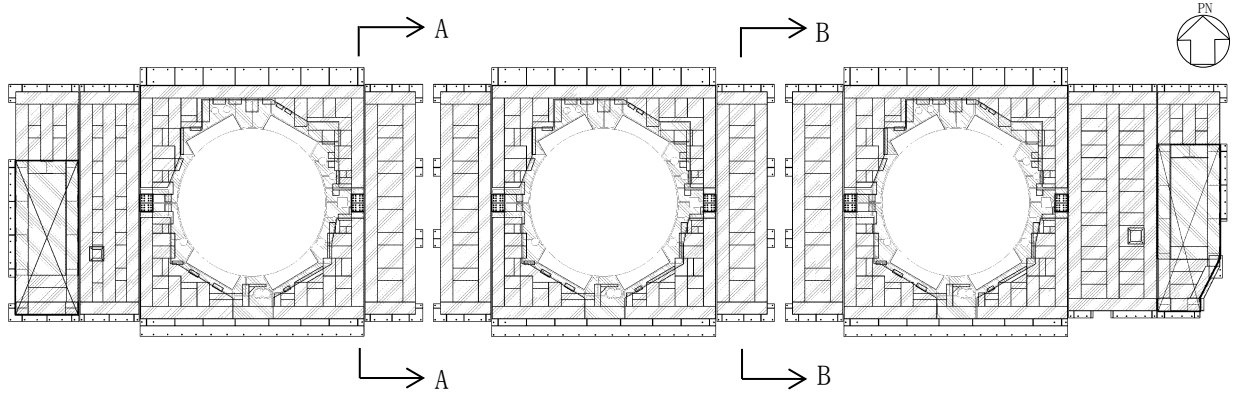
(2) 取水槽循環水ポンプエリア防護対策設備 平面図 (a 部詳細図)
